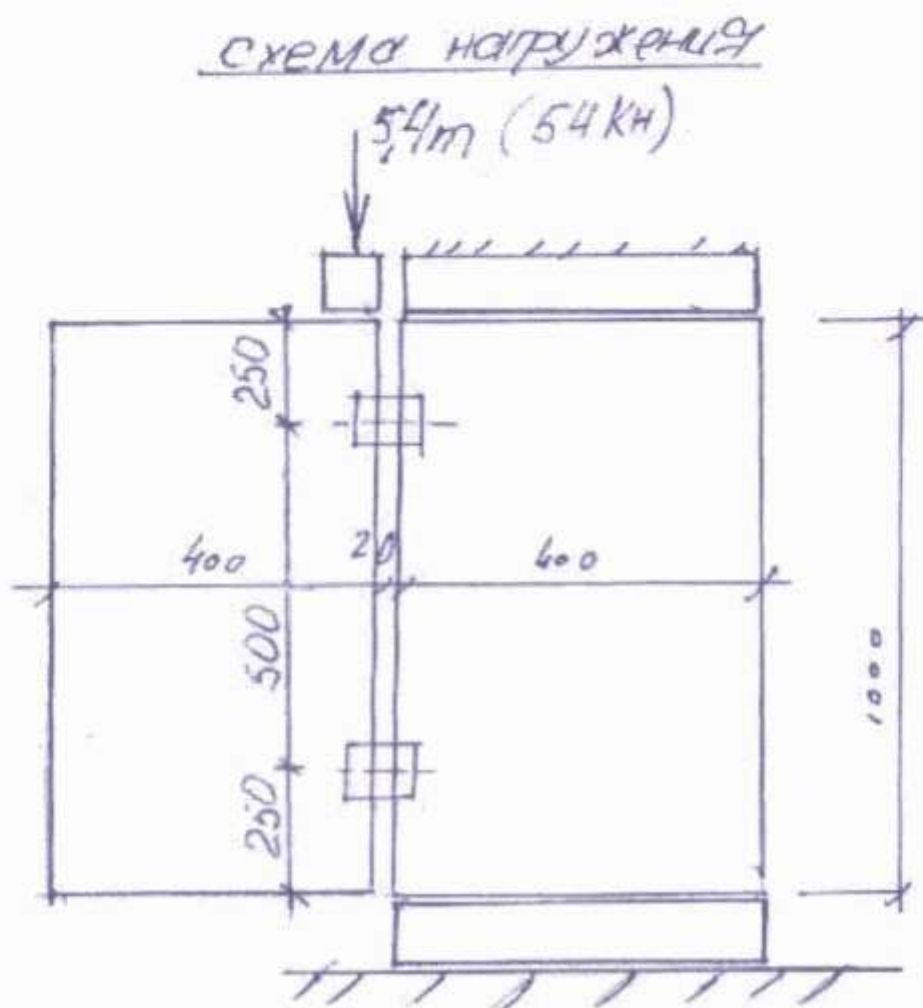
Схема испытаний опытного образца на сдвиг.
